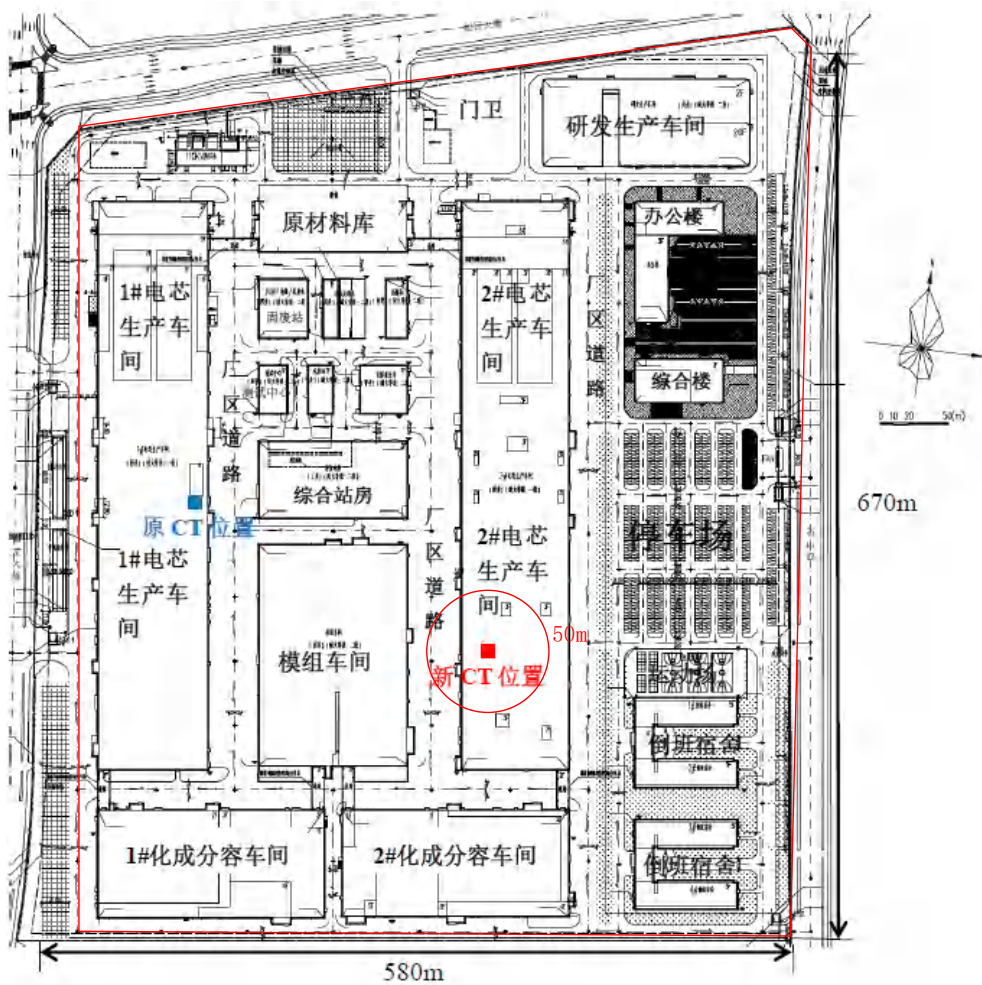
耀能公司总平面布置图 (红框代表厂区范围)
